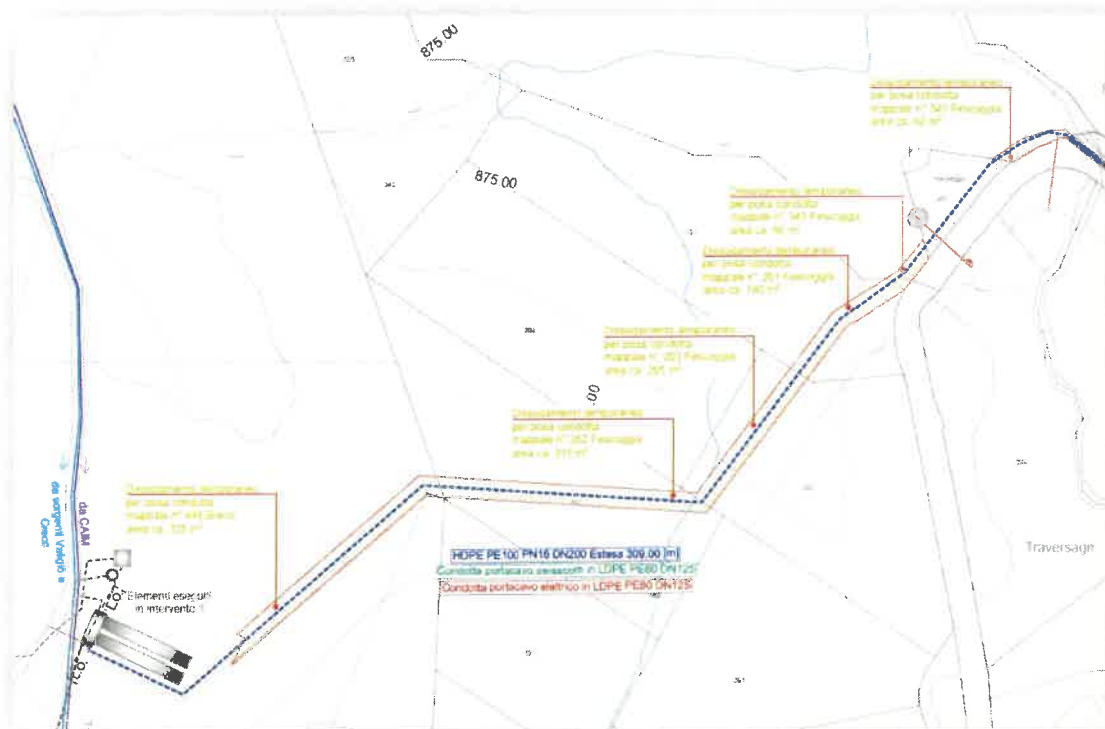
Stralcio planimetrico con individuato il tracciato su bosco per l'intervento 3
